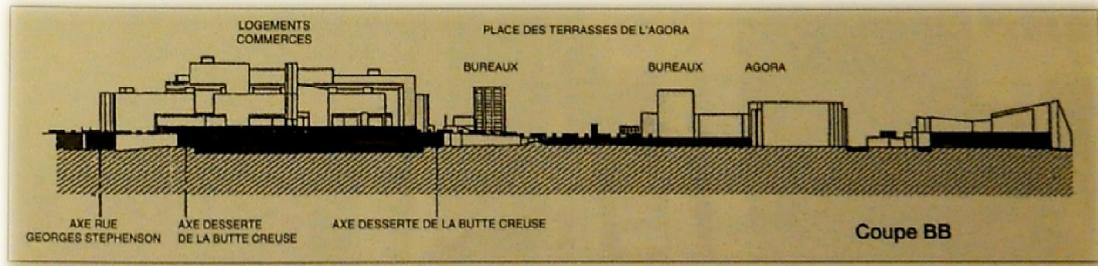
Plan de coupe de la dalle de l'Agora. Source : colloque « Urbanisme de dalles : continuité et ruptures », Cergy-Pontoise, Sept. 1993.
